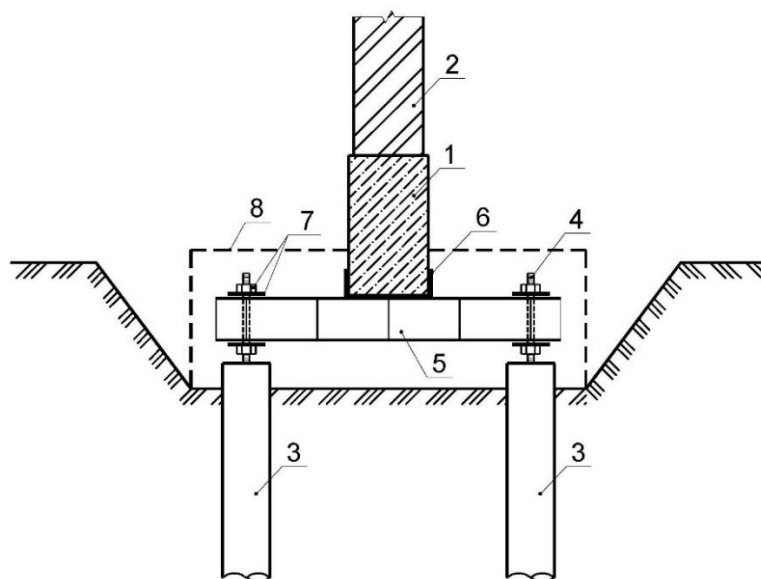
Разгрузка существующего фундамента для полной передачи внешней нагрузки от стен здания через сваи на глубокие слои основания:
